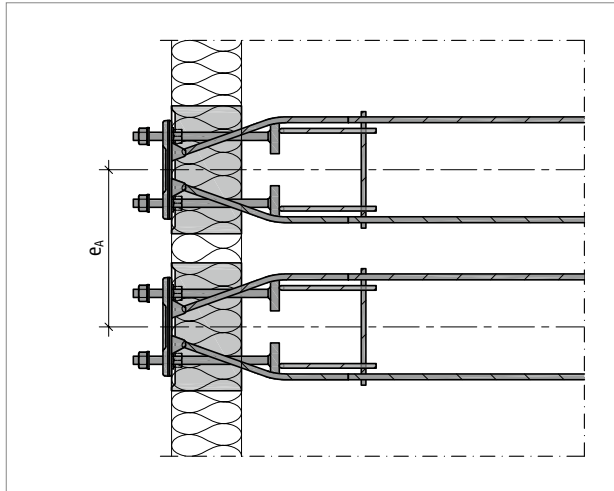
Schöck Isokorb® XT type SQ : espacement axial
